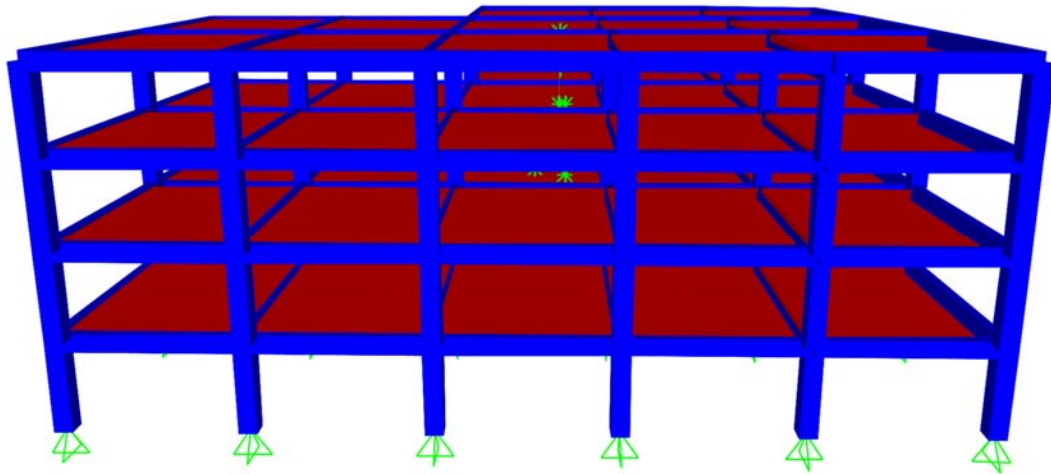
Segunda vista 3D del modelo de la estructura de base fija.
